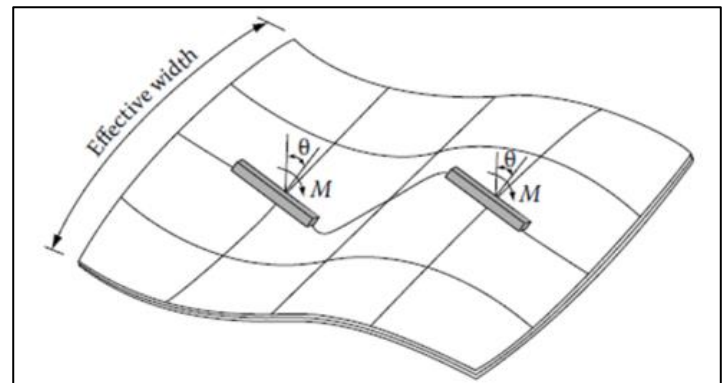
Réponse des dalle-cadres plats aux charges latérales : Compatibilité de déplacement entre la dalle et les murs
